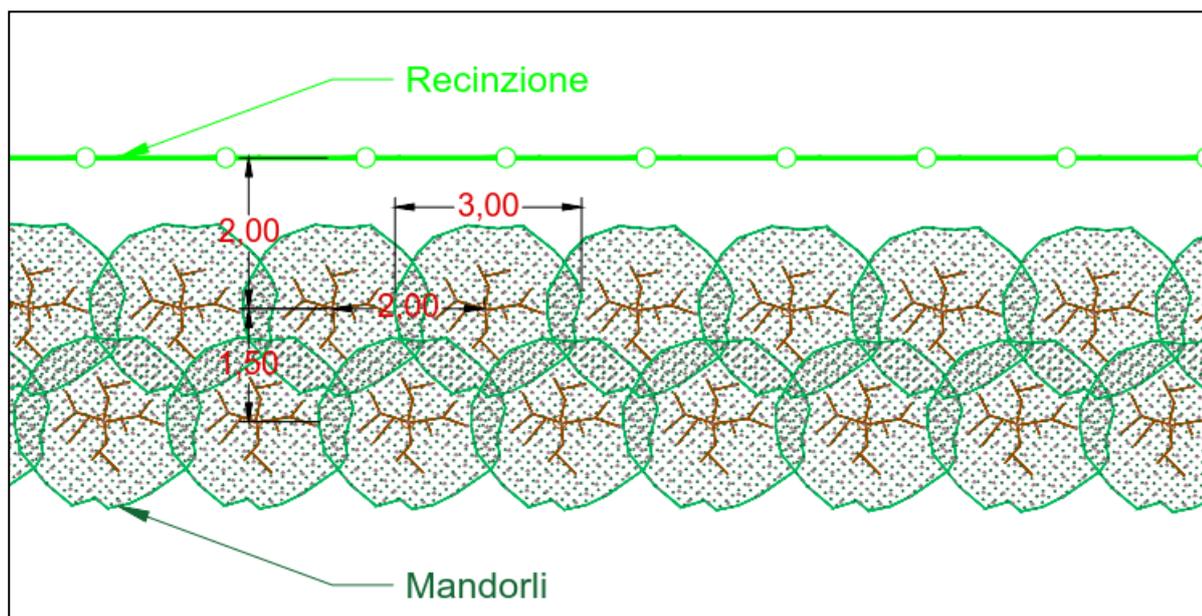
Sesto d'impianto della fascia perimetrale con larghezza 5 m
